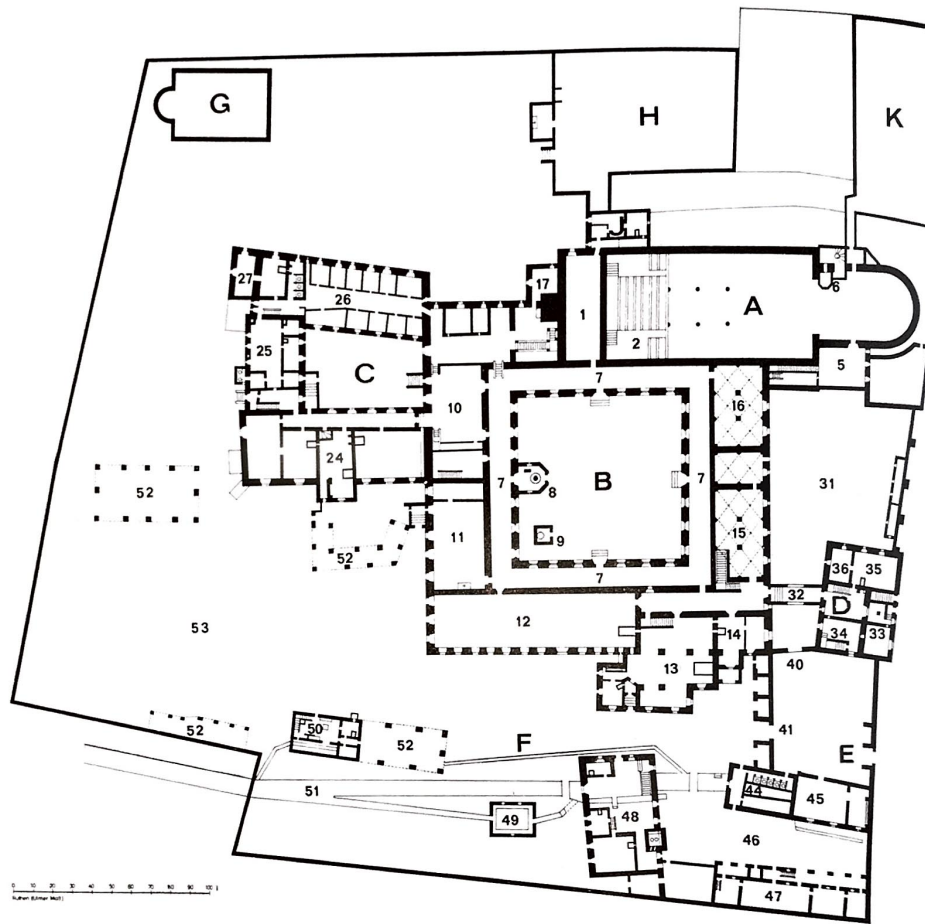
Umzeichnung des Grundrisses vom Erdgeschoss des Söflinger Klarissenklosters
